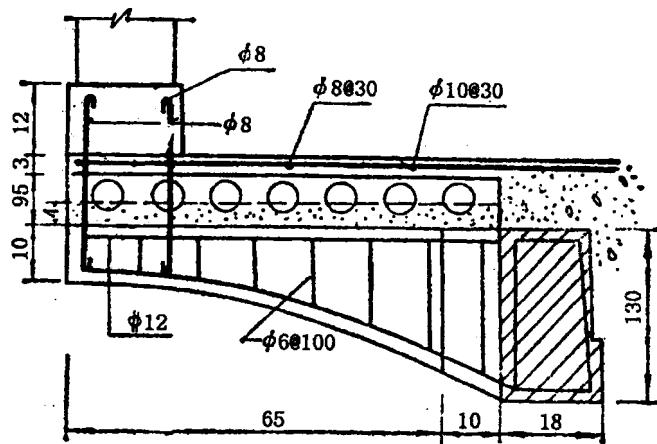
桁架拱桥加宽悬臂构造 (单位: cm)
